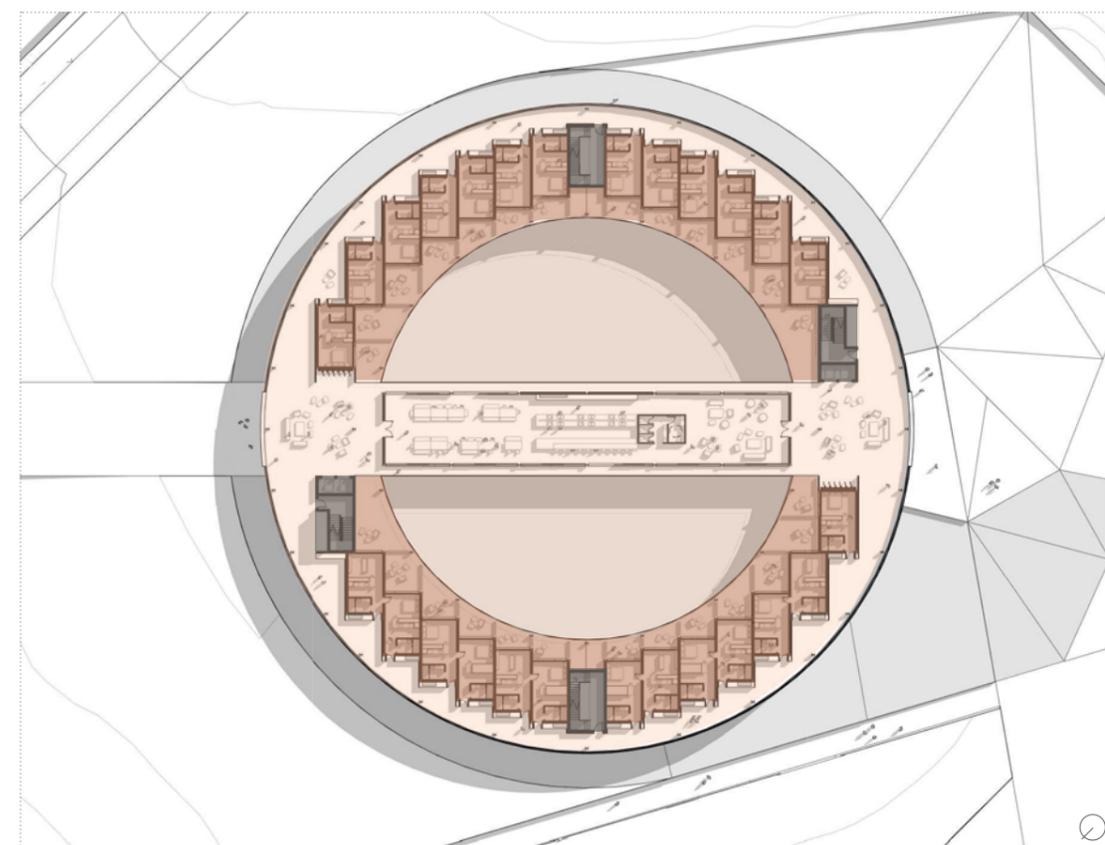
| Planta de divisão do espaço privado e coletivo, (Silo A), Escala 1:800
